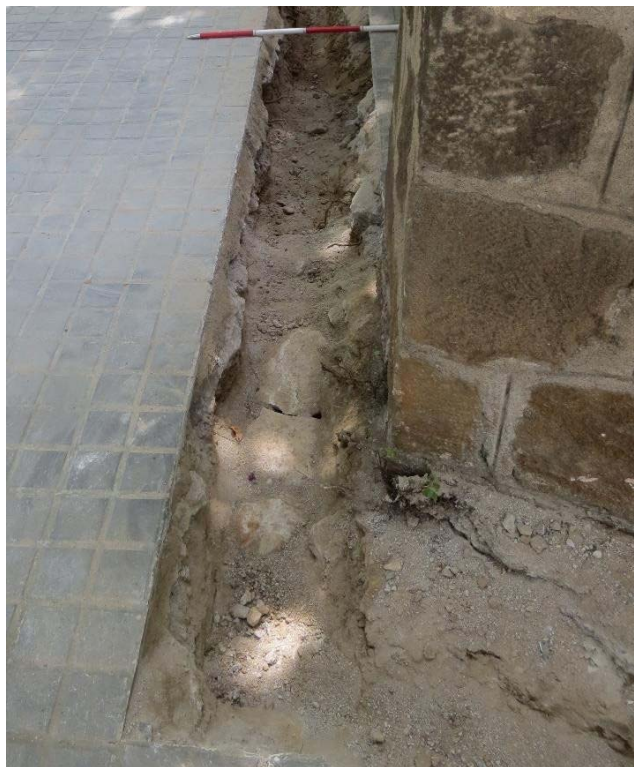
Detall de l'estructura UE 111, en aquest cas lligant amb la pilastra de la cantonada del mur.
